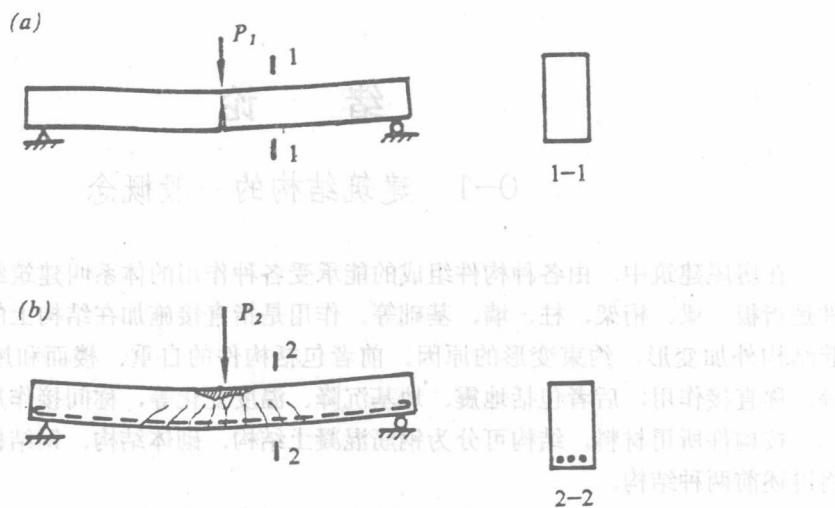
混凝土受压和受拉时的破坏形式 (a) 索混凝土梁的破坏; (b) 钢筋混凝土梁的破坏
